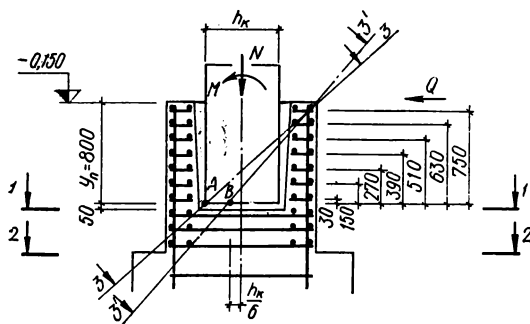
Сечения для расчета поперечной арматуры подколонника.
